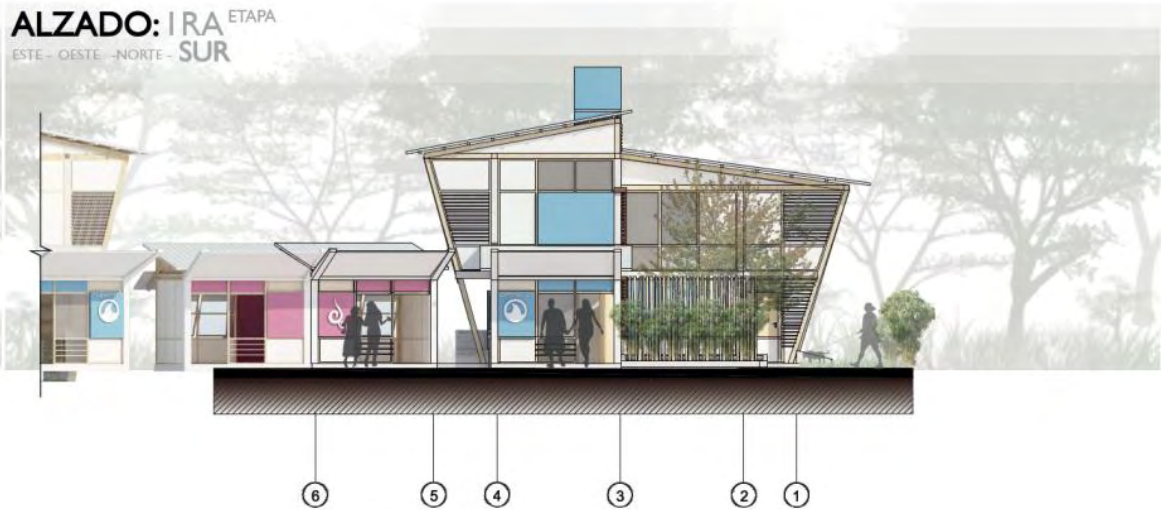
Fachada 04, alzado Sur A2 Fuente: propia
